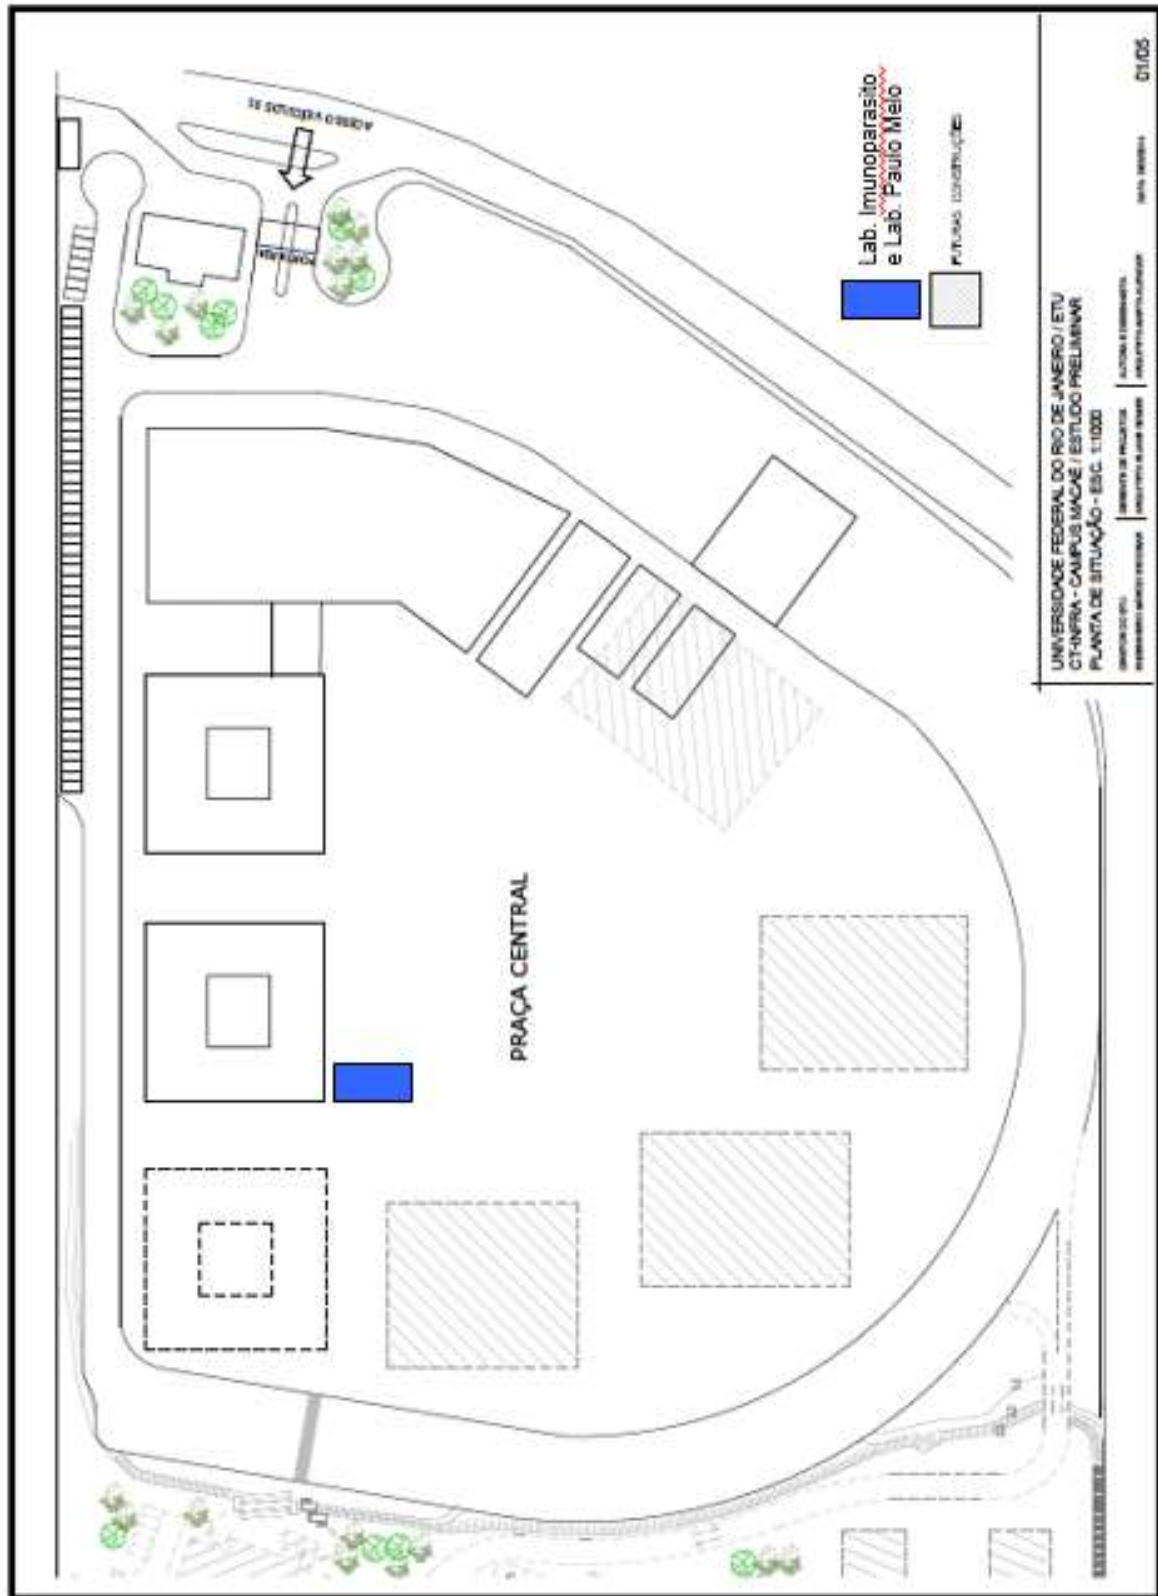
Planta de situação do Campus, Arquivo da UFRJ.
